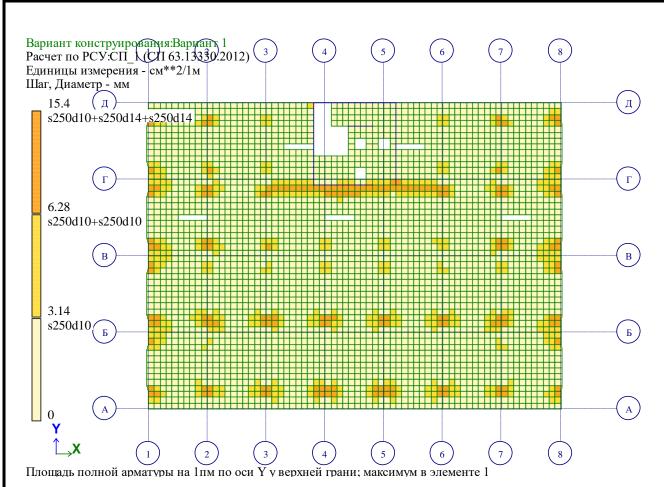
Расчетное армирование плиты покрытия по оси Y у верхней грани.
